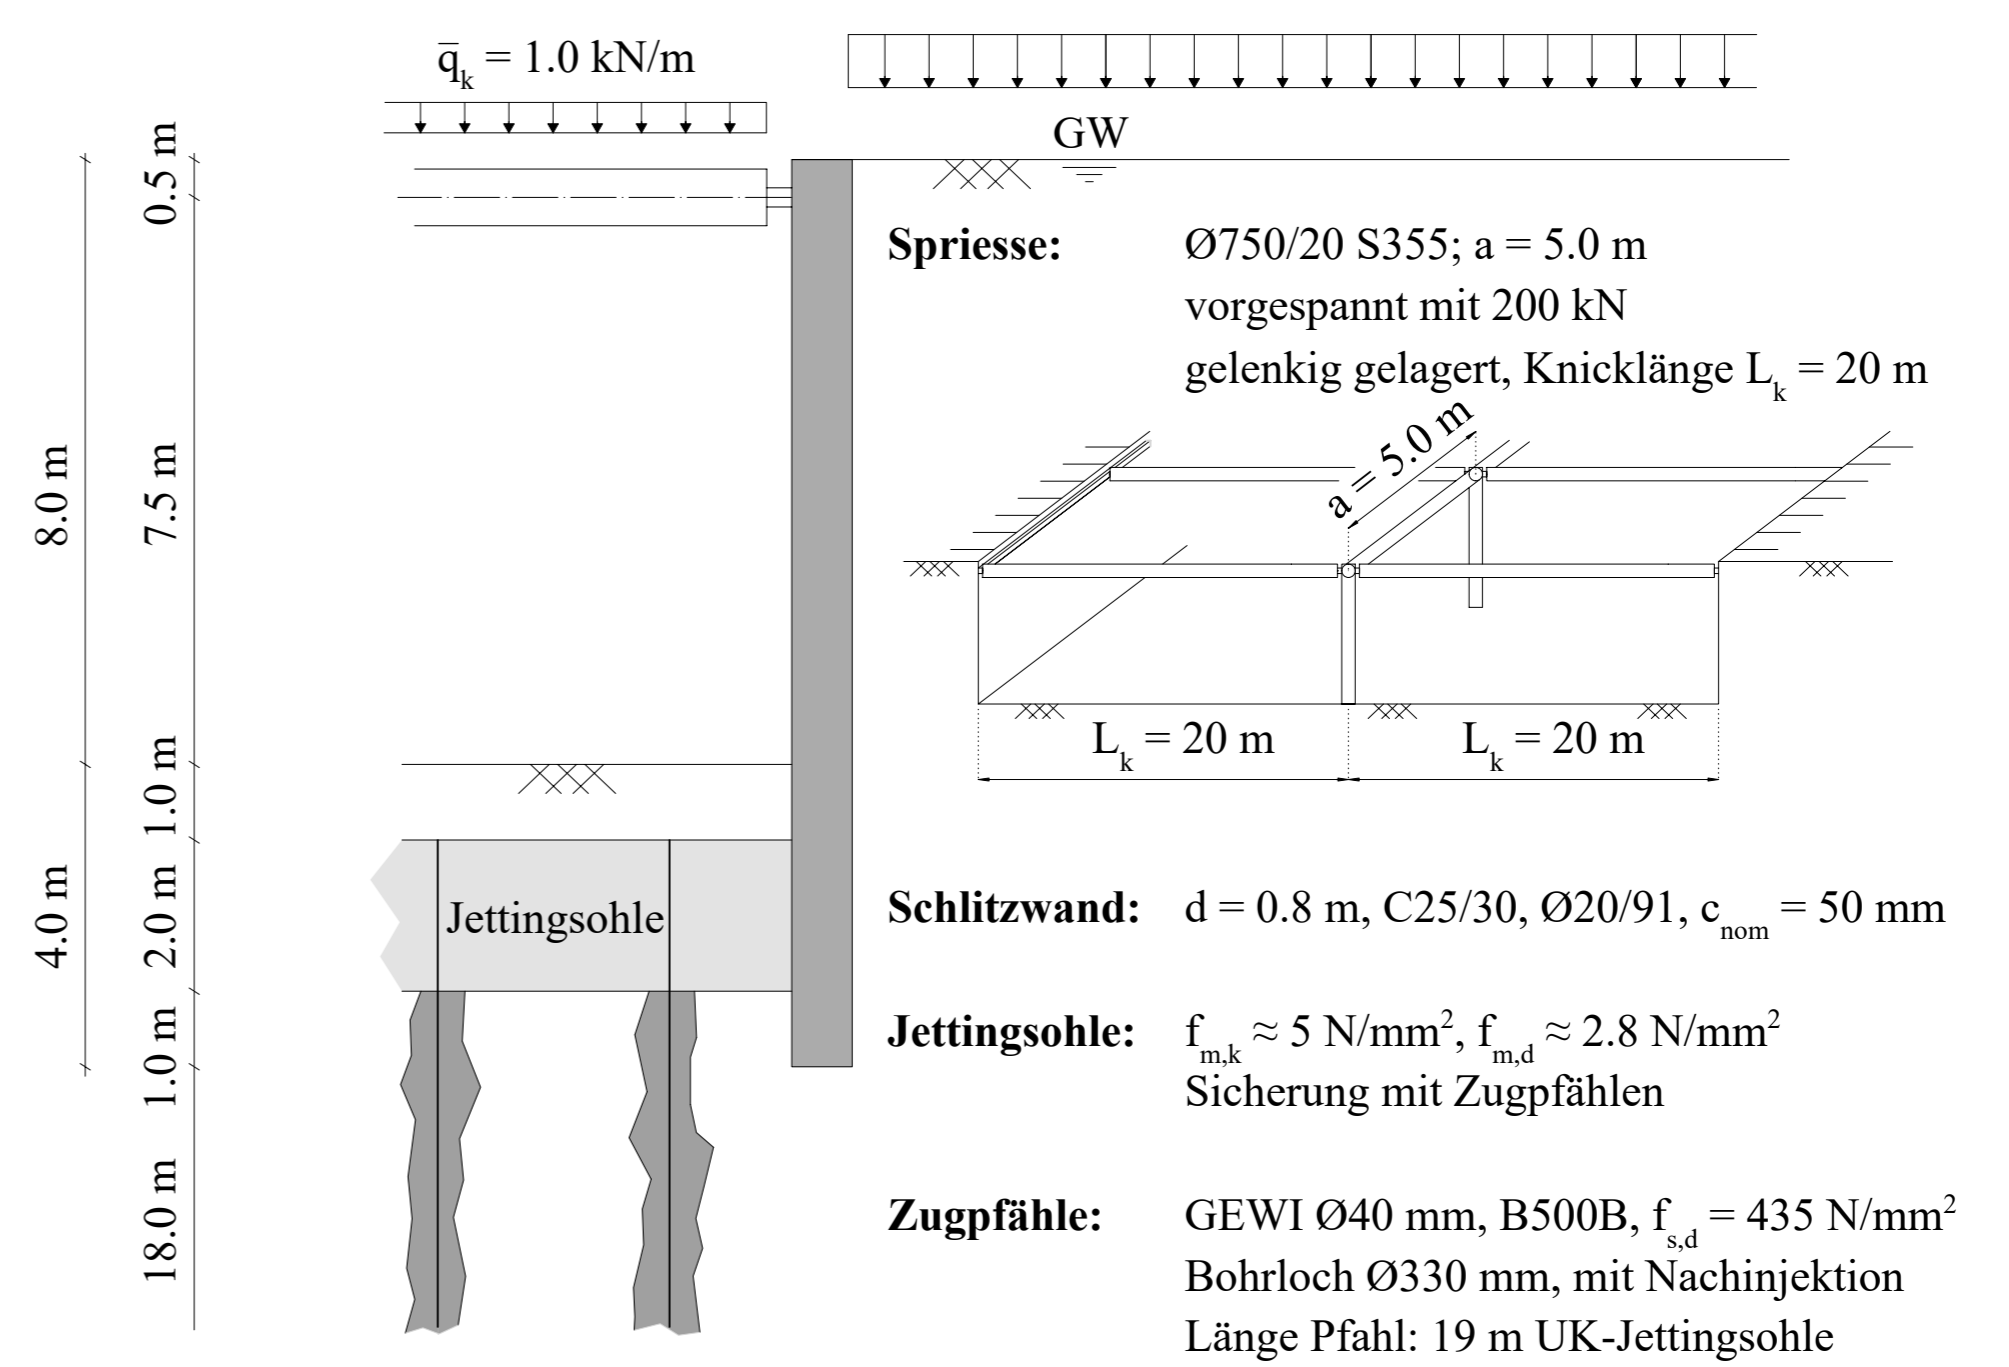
Geplante Baugrube inklusive Bauteilabmessungen.
